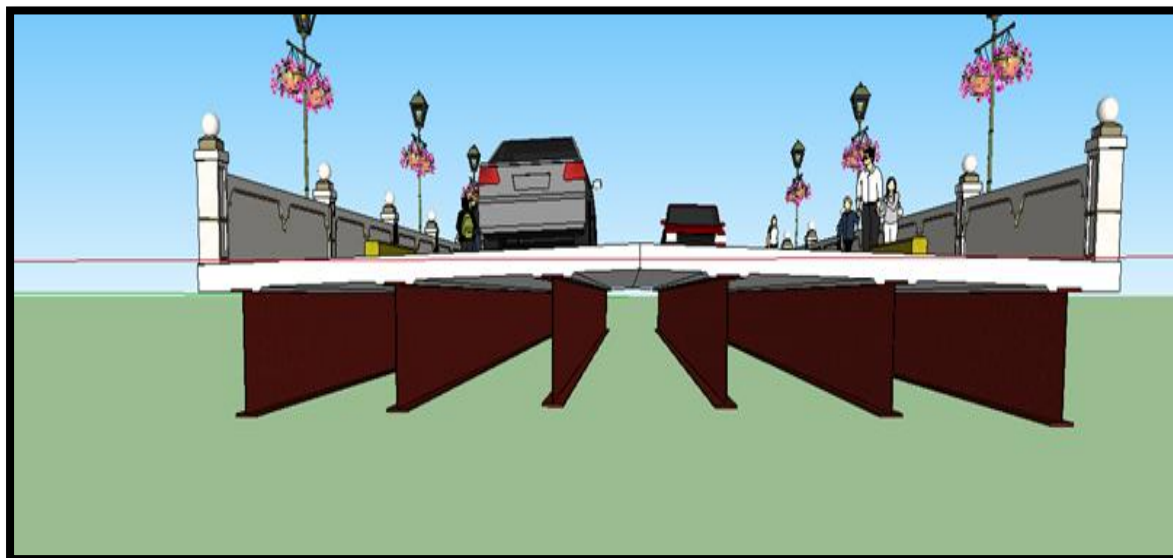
Corte frontal de Superestructura de puente Guadalupe, vigas metálica
